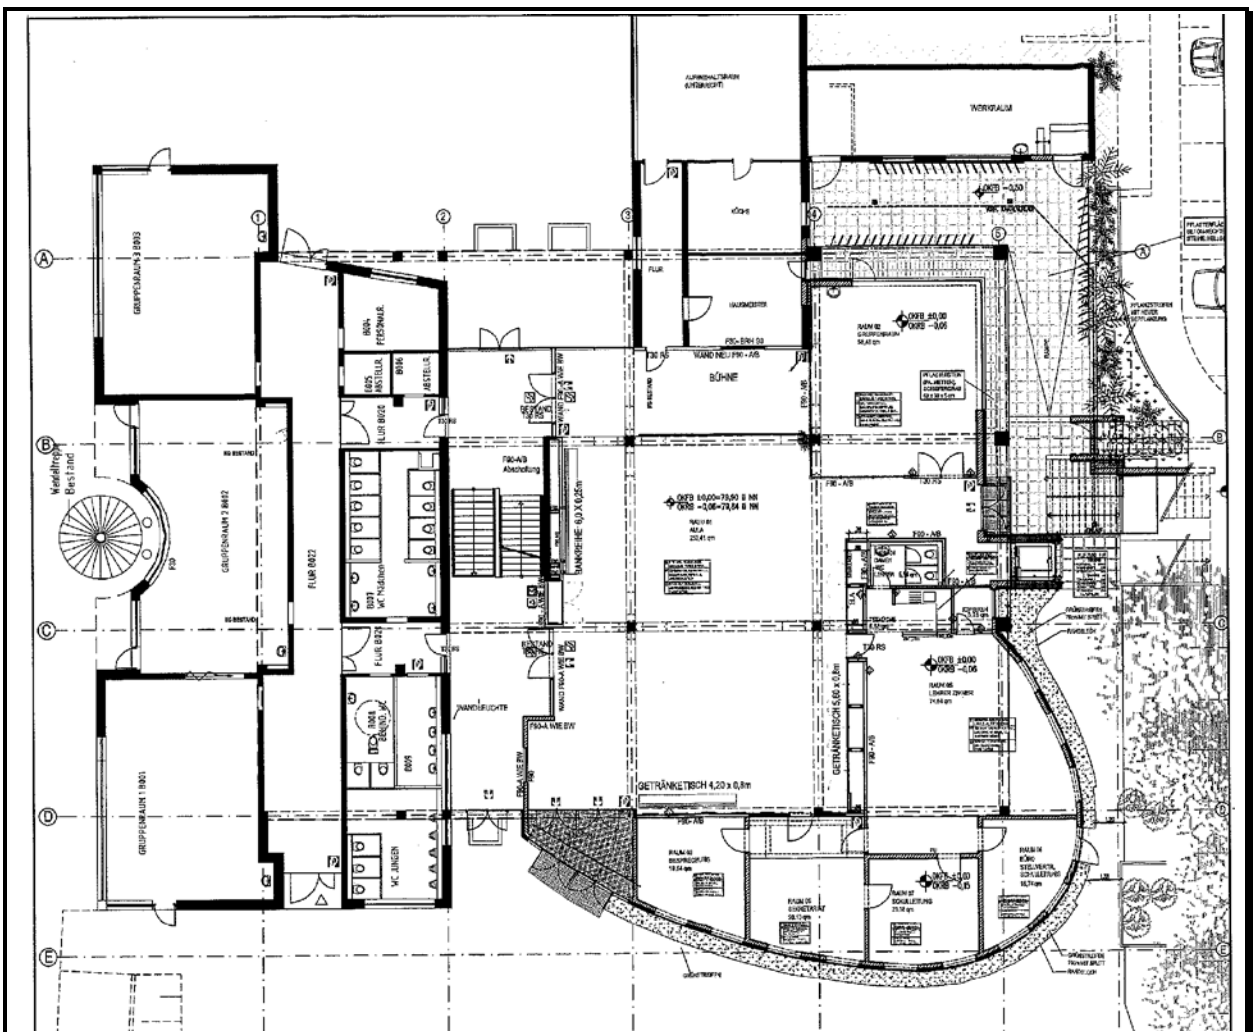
Grundriss Erdgeschoss Bodelschwingschule
